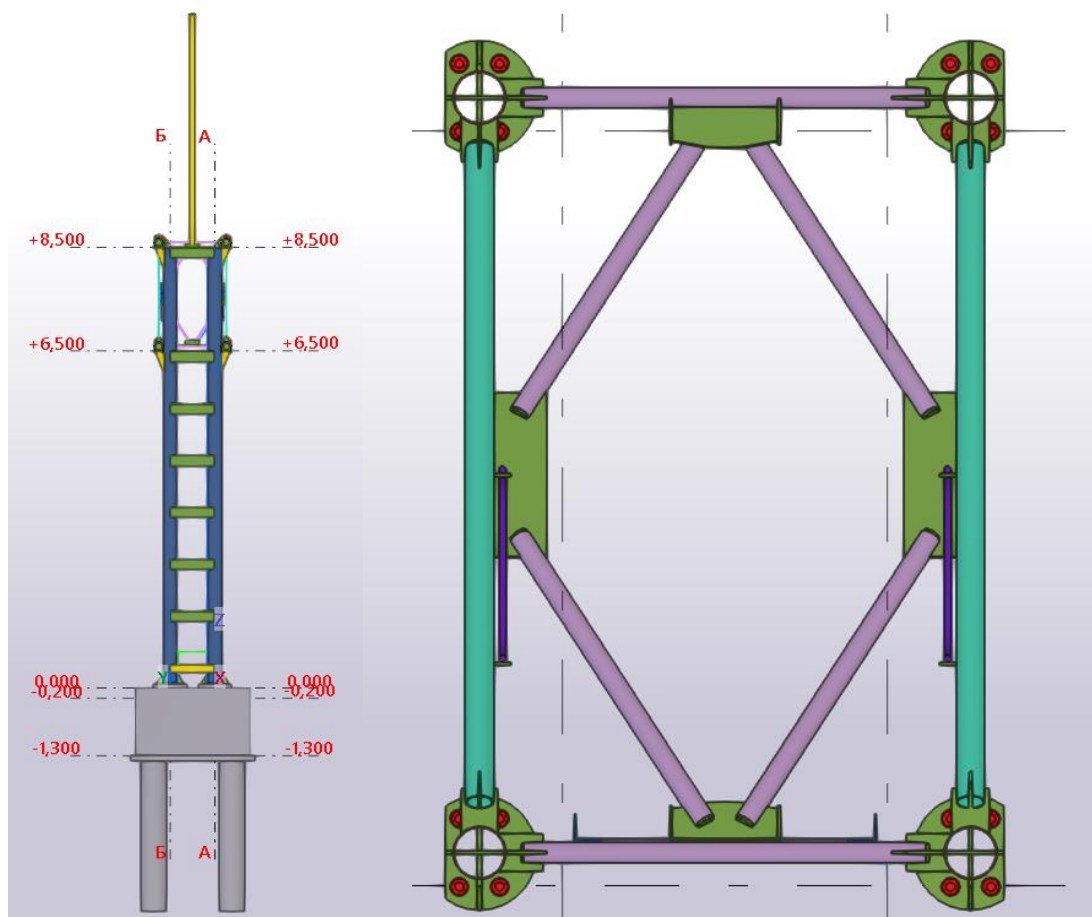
Поперечний вид просторової конструкції та блоку ферми
